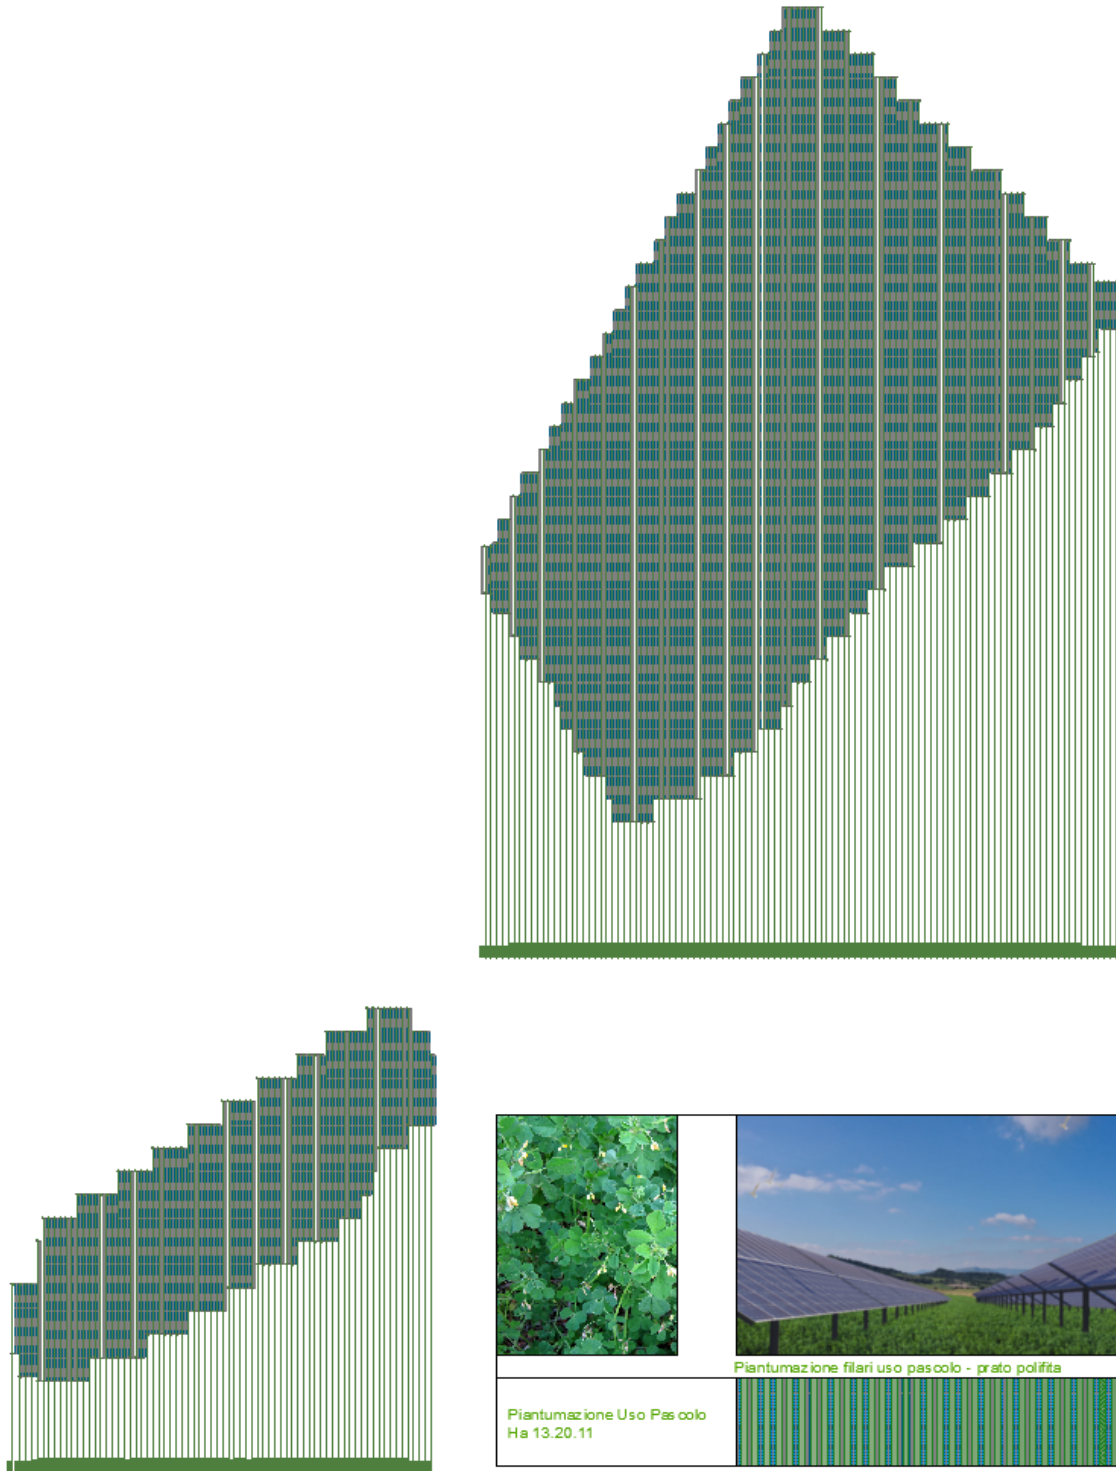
Sviluppo quotato planimetria aree di coltivazione
